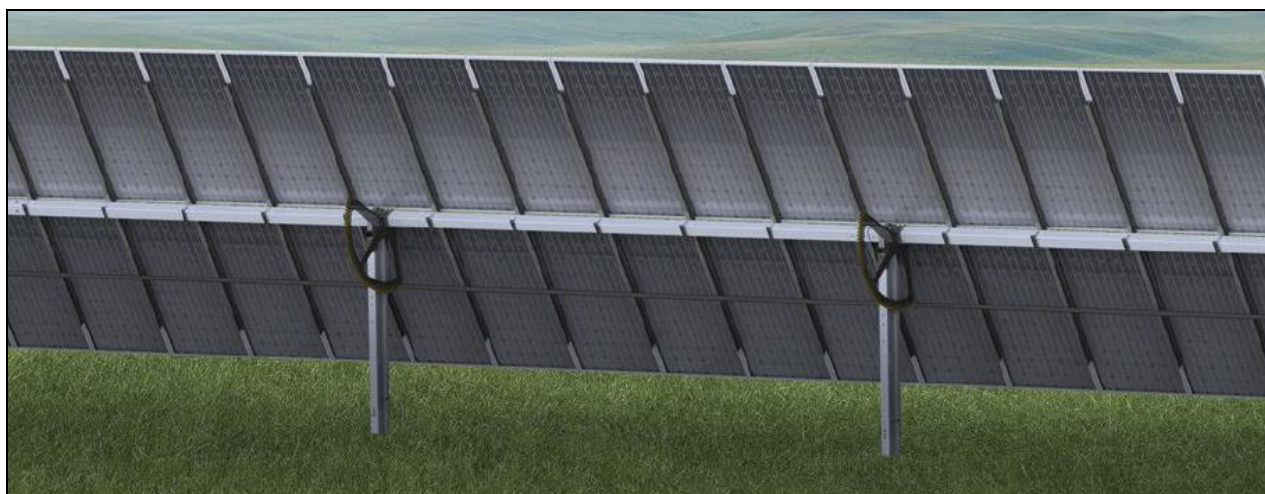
Rappresentazione della struttura di supporto vista frontale
